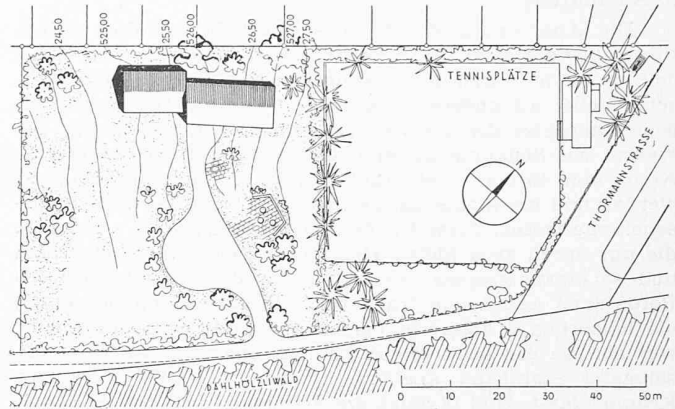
Kindergarten Thormannstrasse in Bern, Lageplan 1:1500
